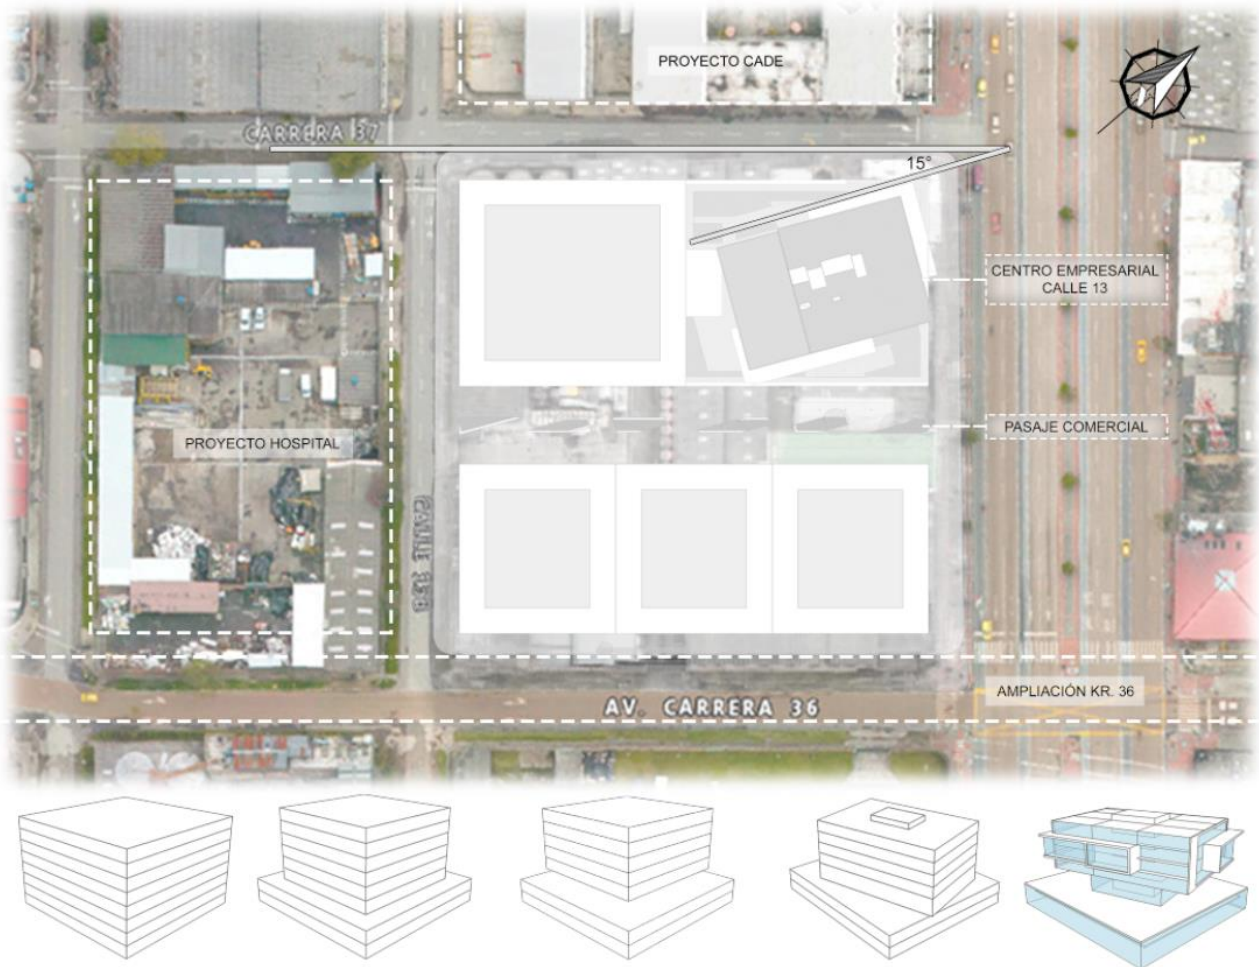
Esquema de planta general del proyecto – Exploración volumétrica del volumen
